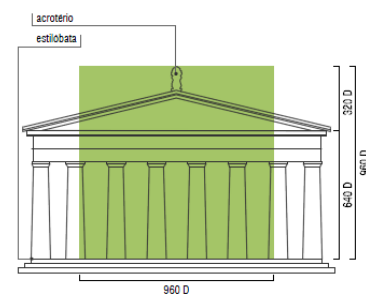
Fachada leste do Pártenon e a proporção de 6:6. (Fonte: ilustr. do autor)
